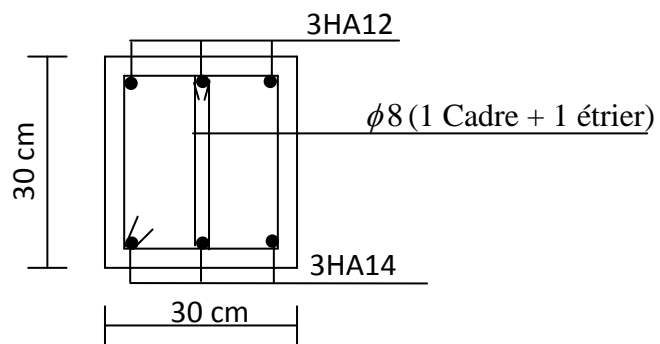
Schéma de ferrailage de la poutre palière.
